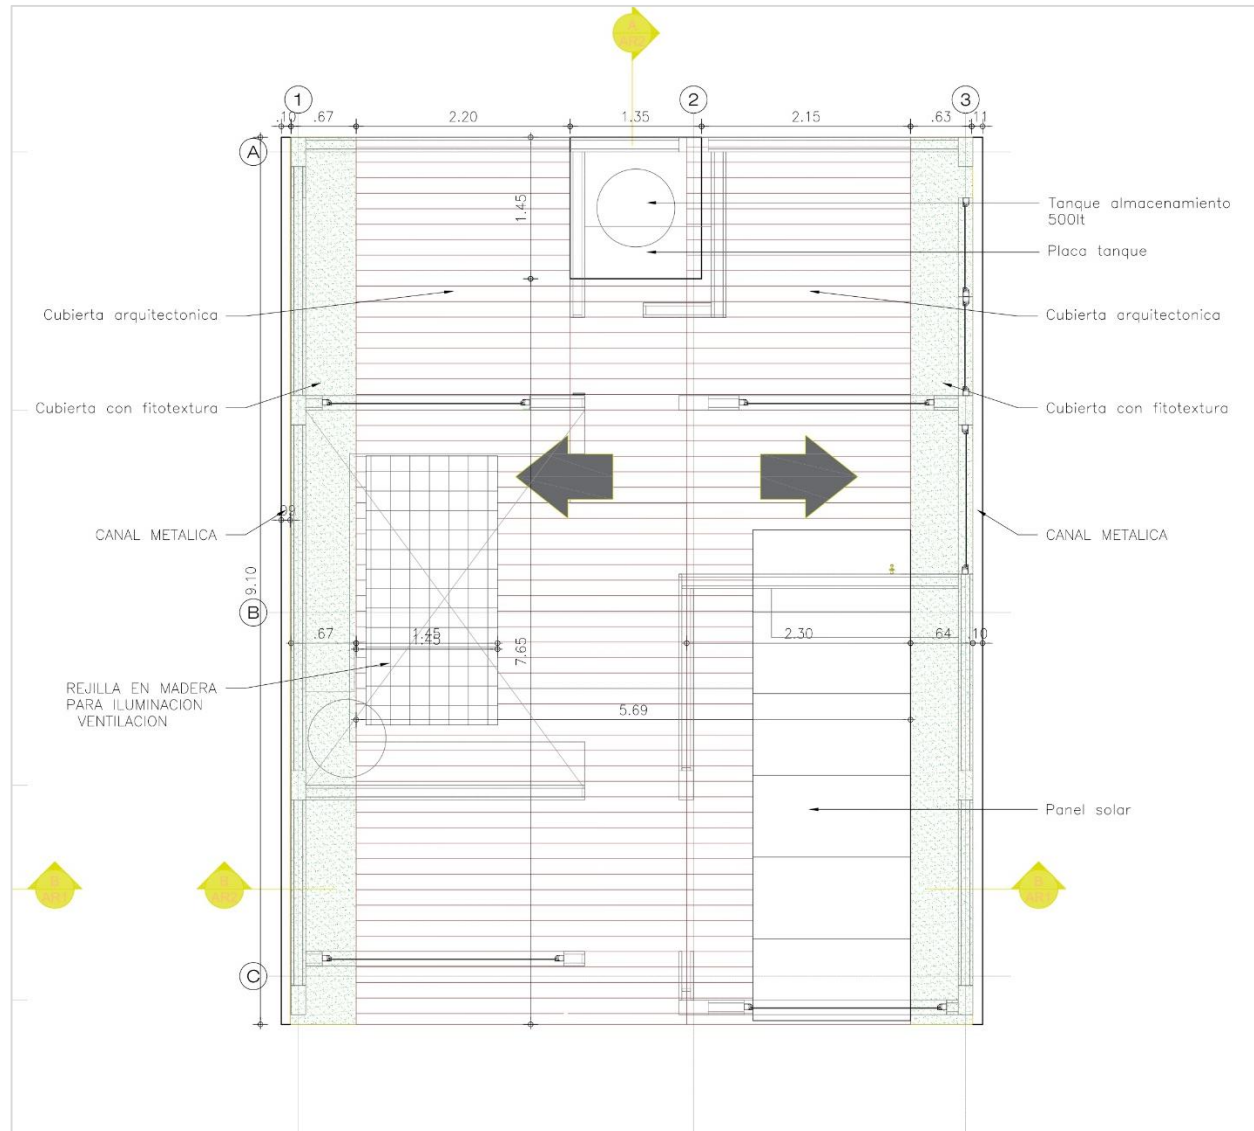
Plano cubierta vivienda sostenible. Fuente: Propia
